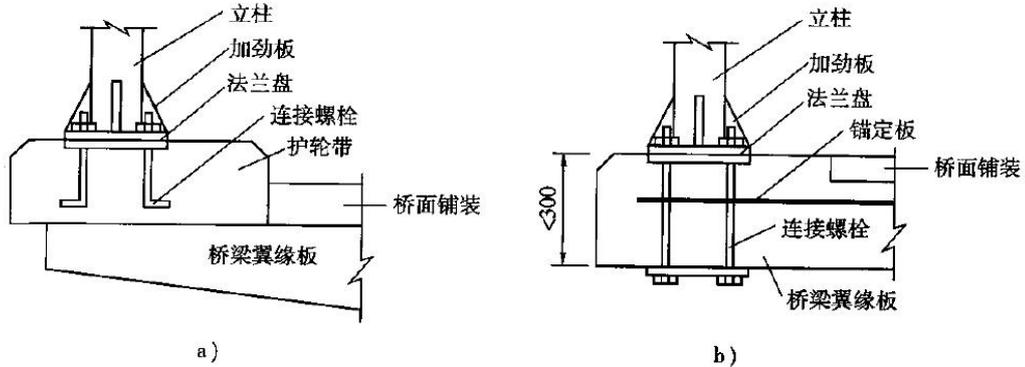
地脚螺栓连接方式（尺寸单位：mm）
